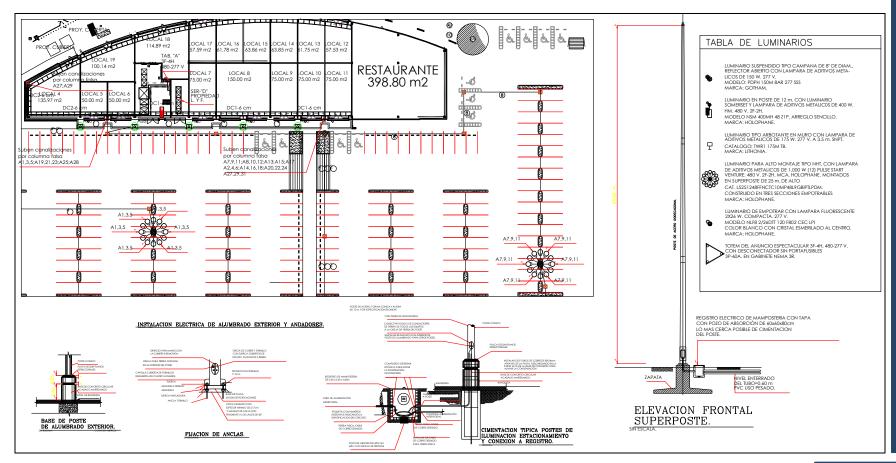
Plano Alumbrado exterior de emergencia, Referencia Plano: CPJ1-IELU-05.DWG
